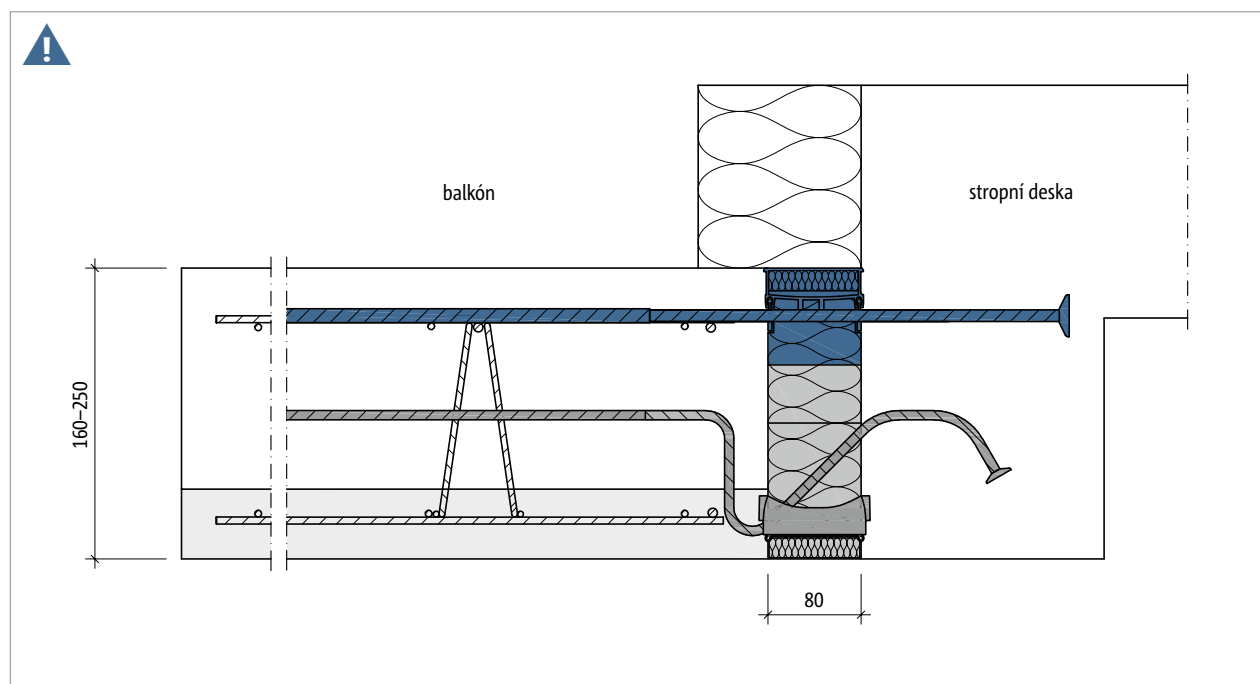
Schöck Isokorb® T typ KL-O-F: Poloprefabrikovaný balkón nadvýše-
